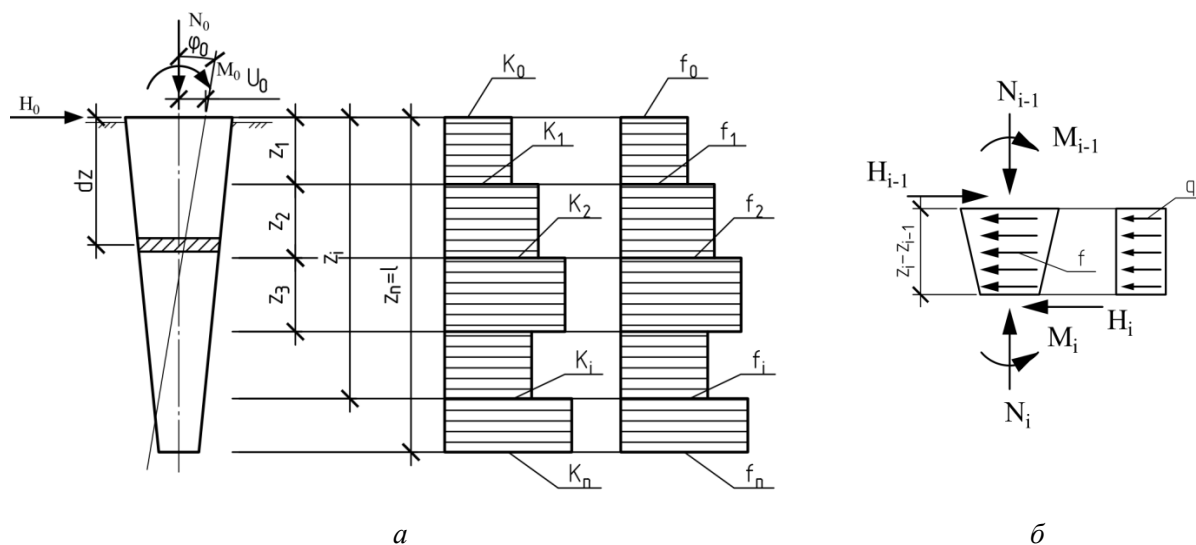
Расчетная схема пирамидальной сваи: *a* – схема нагрузок и сопротивления грунта для сваи; *б* – то же, *i*-го участка сваи
